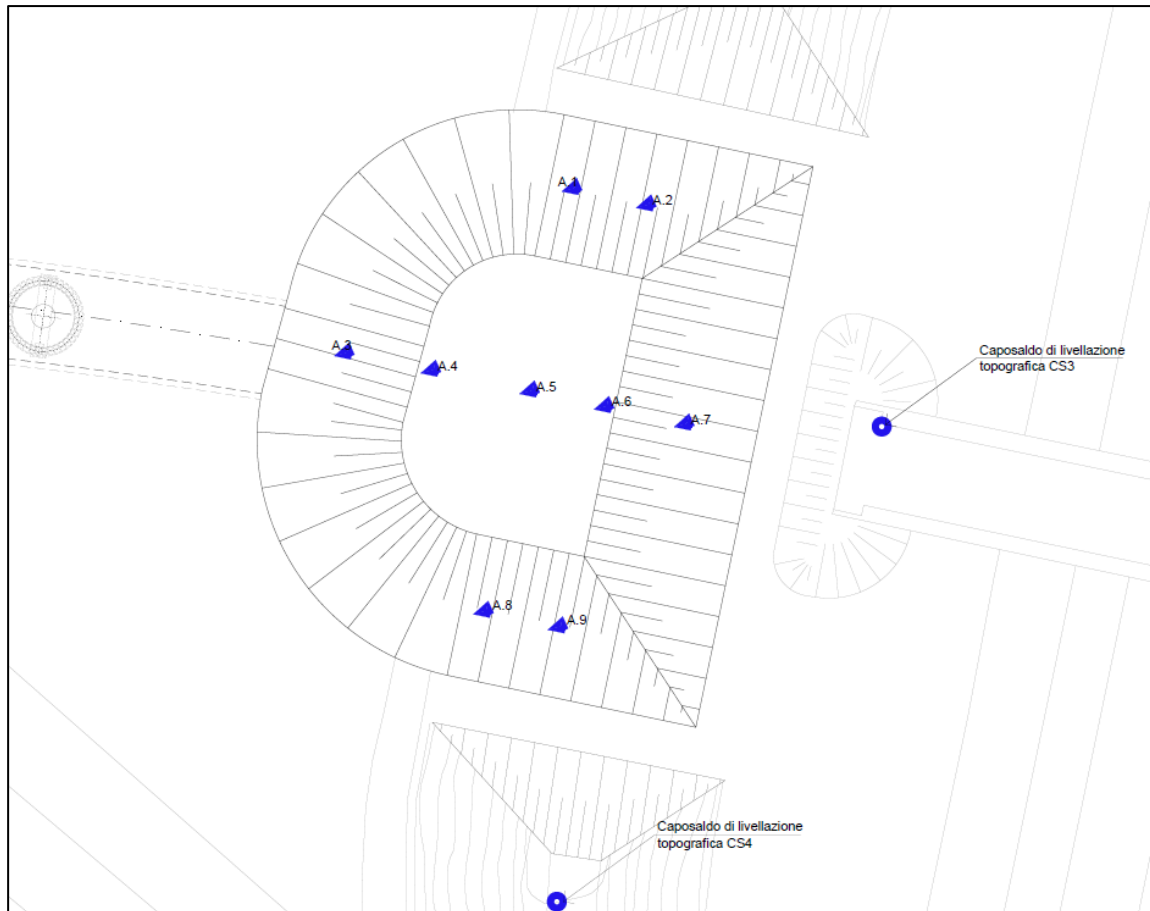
Stralcio planimetria ubicazione assestimetri
